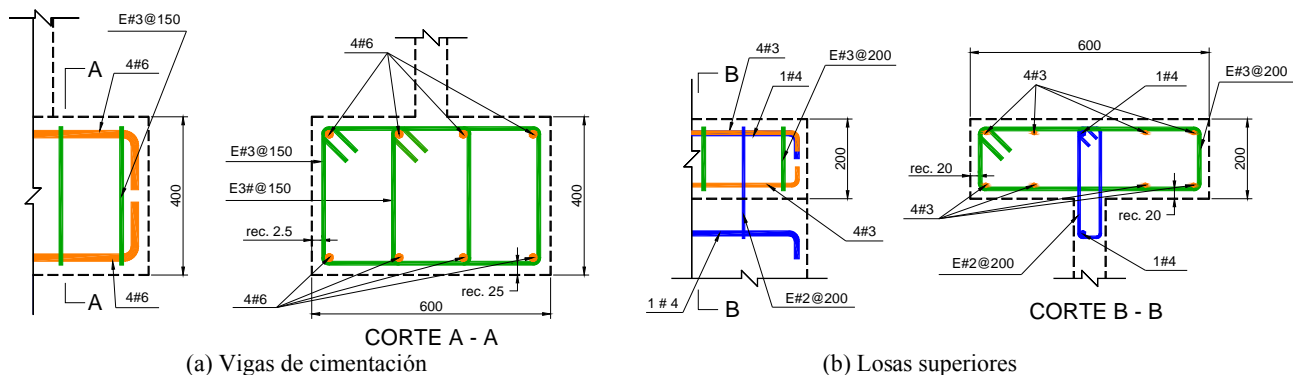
Armado de vigas de cimentación y losas superiores (dimensiones en mm)
